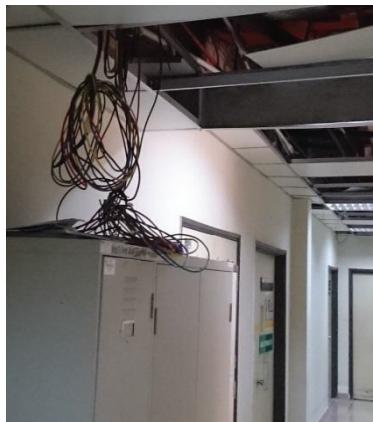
Kerja pendawaian semula elektrik dan papan agihan di blok 42
